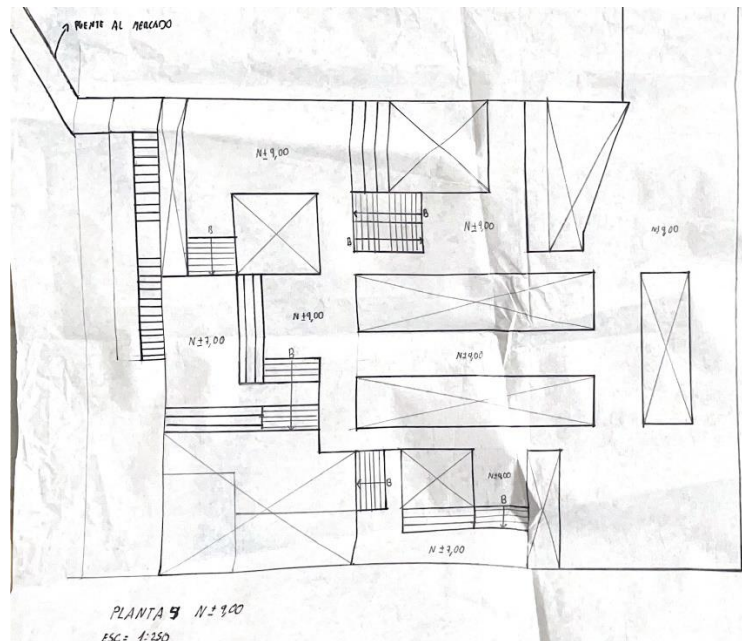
Dibujo mano alzada planta +9.00. Elaboración propia, 2024.
